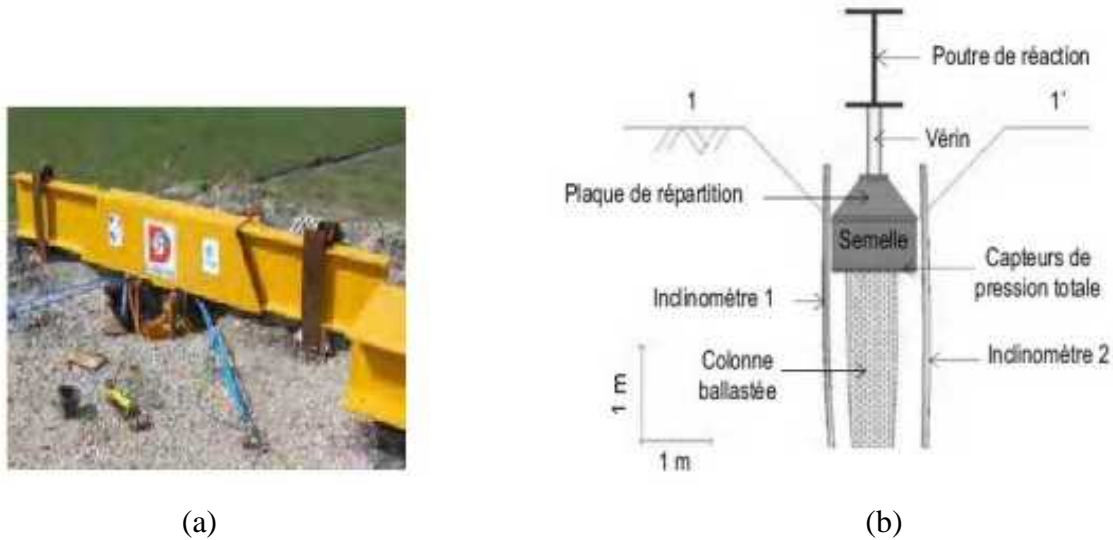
Essai de chargement en grandeur réelle : (a) Dispositif de chargement d'une colonne isolée ; (b). Coupe schématique de l'essai. (Corneille, 2007)
